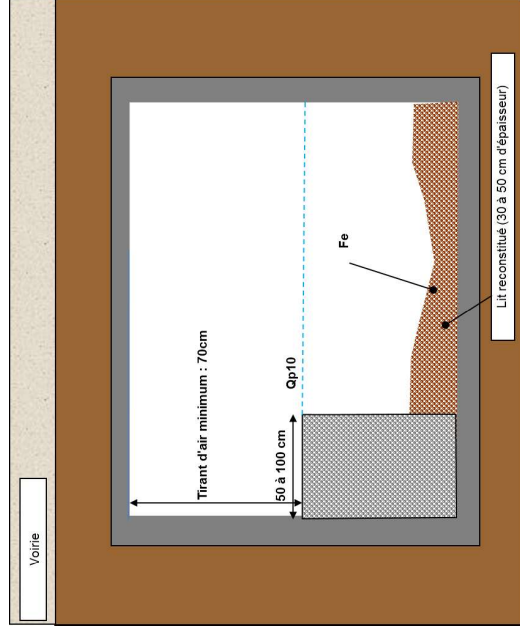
Coupe de principe d'un ouvrage équipé d'une banquette pour le passage de la petite faune terrestre et semi-aquatique
